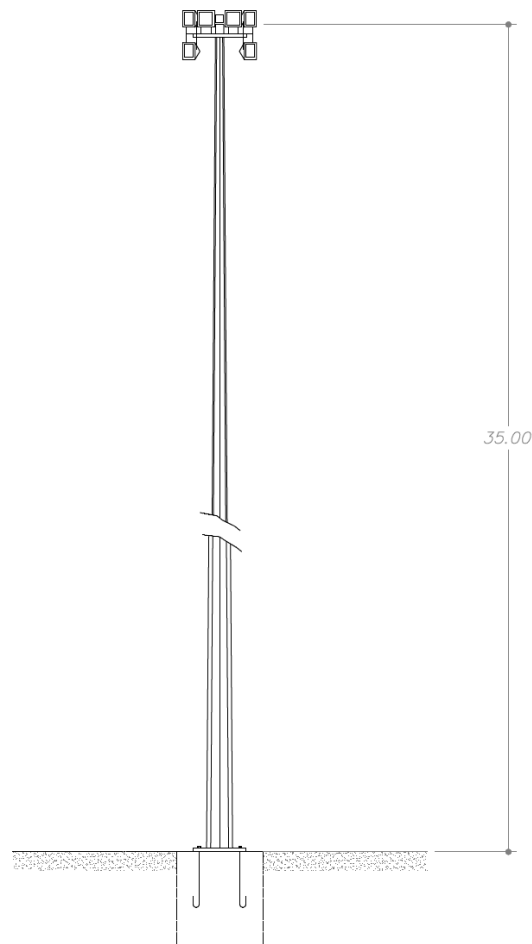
Tipologico torre faro per l'illuminazione di impianto.
